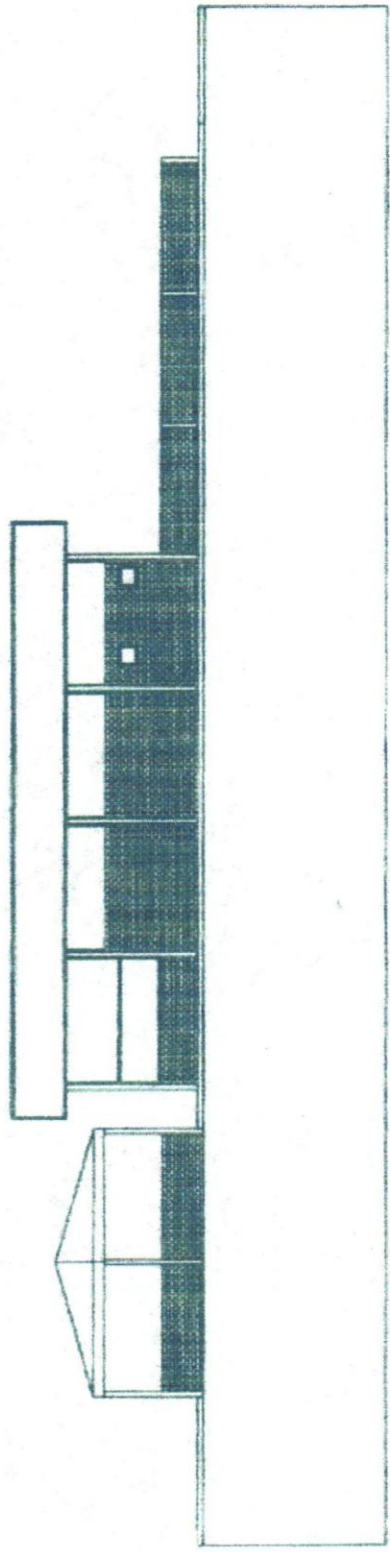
Vivero U.C.A.B.; plano de estructura – fachada posterior.
